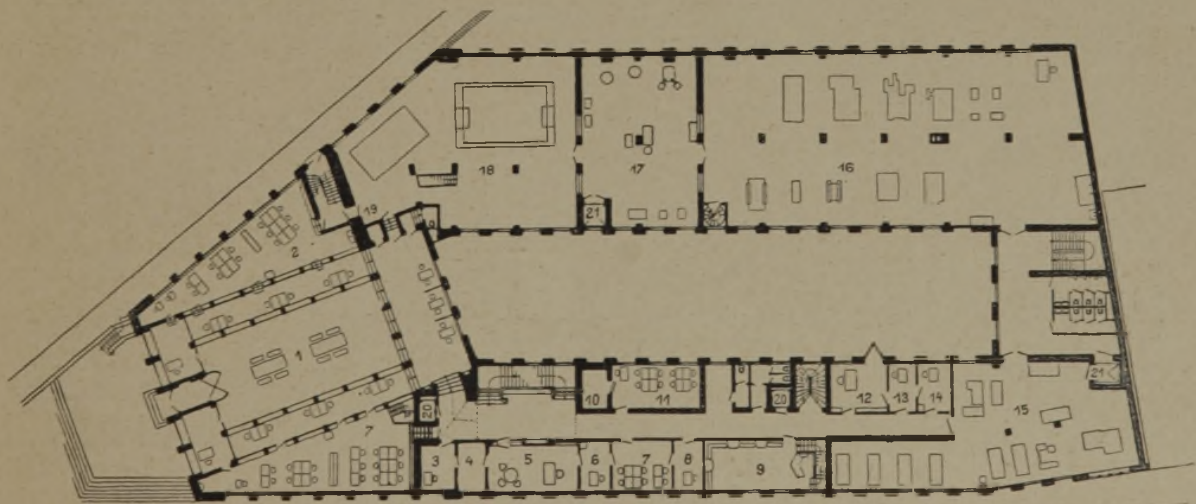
Grundriß des Erdgeschosses. (1 : 600.)
